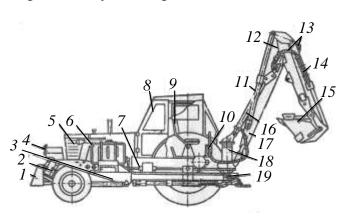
Одноковшовый экскаватор ЭО-2621А: 1 — отвал бульдозера; 2 — гидроцилиндр отвала; 3 — рама навески; 4 — бак; 5 — базовый трактор; 6 — масляный бак с фильтром; 7 — гидронасос; 8 — кабина; 9 — поворотное сиденье; 10 — гидрораспределитель; 11 — гидроцилиндр рукояти; 12 — рукоять; 13 — соединительные трубопроводы; 14 — гидроцилиндр ковша; 15 — ковш; 16 — гидроцилиндр стрелы; 17 — стрела; 18 — поворотная колонка; 19 — гидроцилиндры аутригеров
